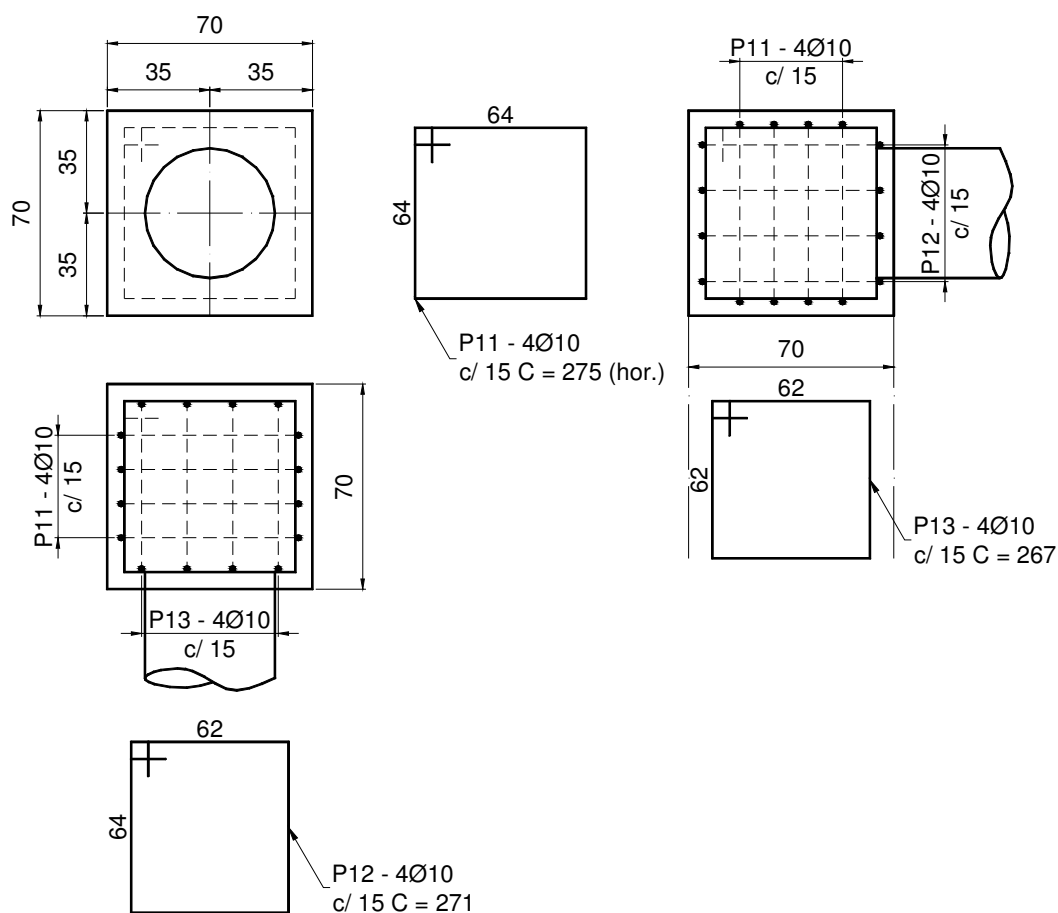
Exemplo de detalhamento das armaduras para o bloco de transição.
